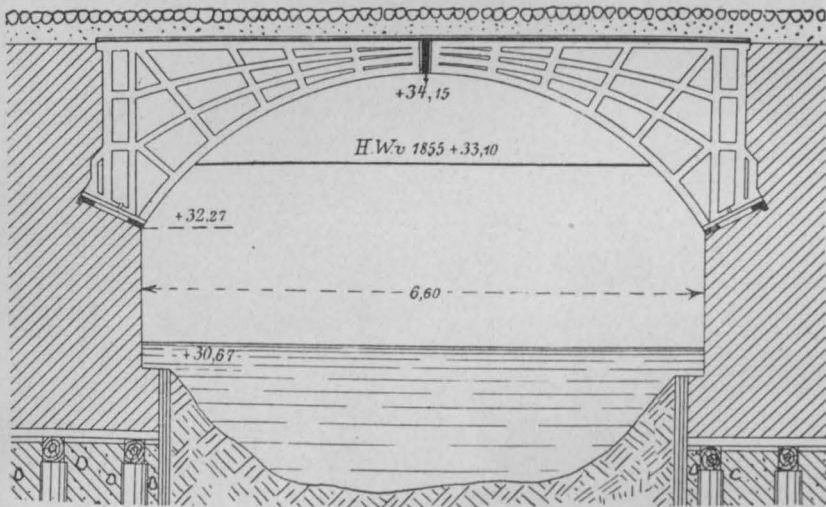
Längsschnitt durch eine Öffnung der Friedrichsbrücke.
